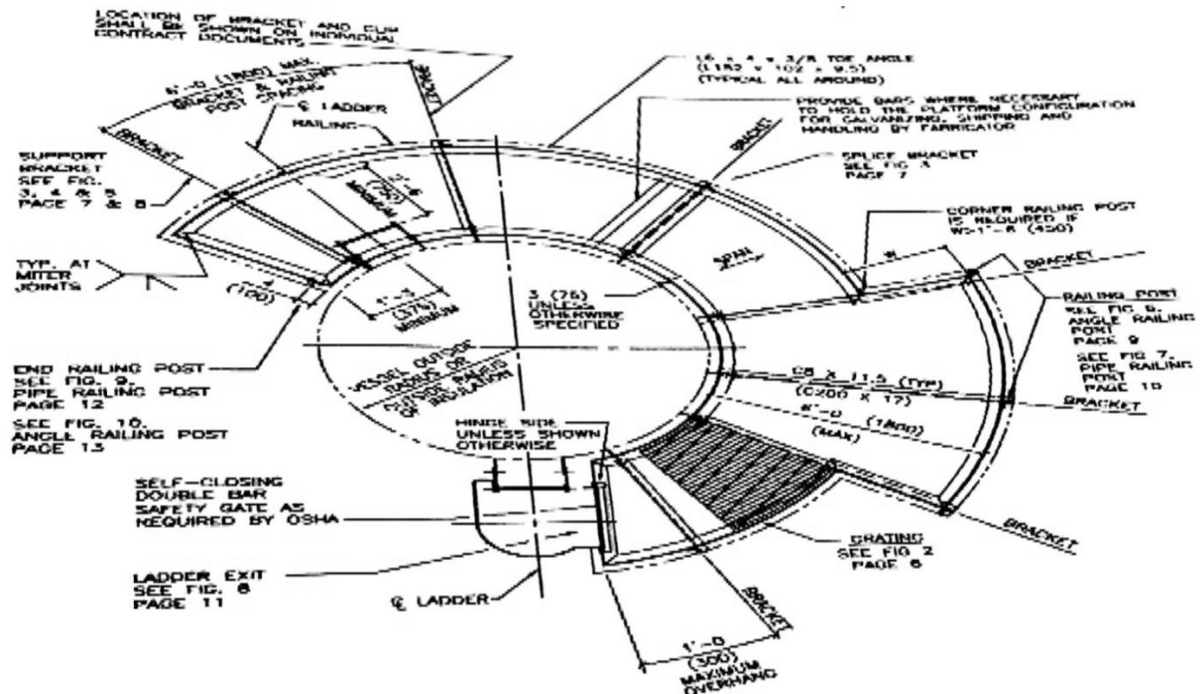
UN DESSIN PLAN TYPIQUE D'UNE PLATEFORME MONTÉE SUR L'ENVELOPPE DE LA COLONNE
